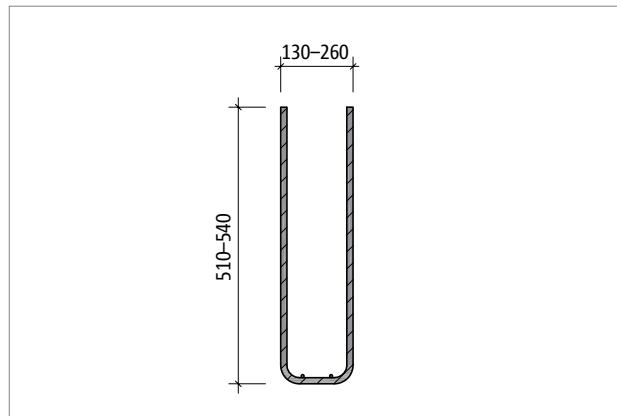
Schöck Sconnex® Typ W Part TB: Zulagebewehrung 3 Ø 12/65 mm; Bügel als Spaltzugbewehrung
